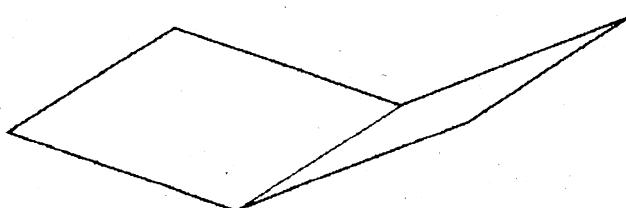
Kehlblech Ausführung mit Wasserfalz
